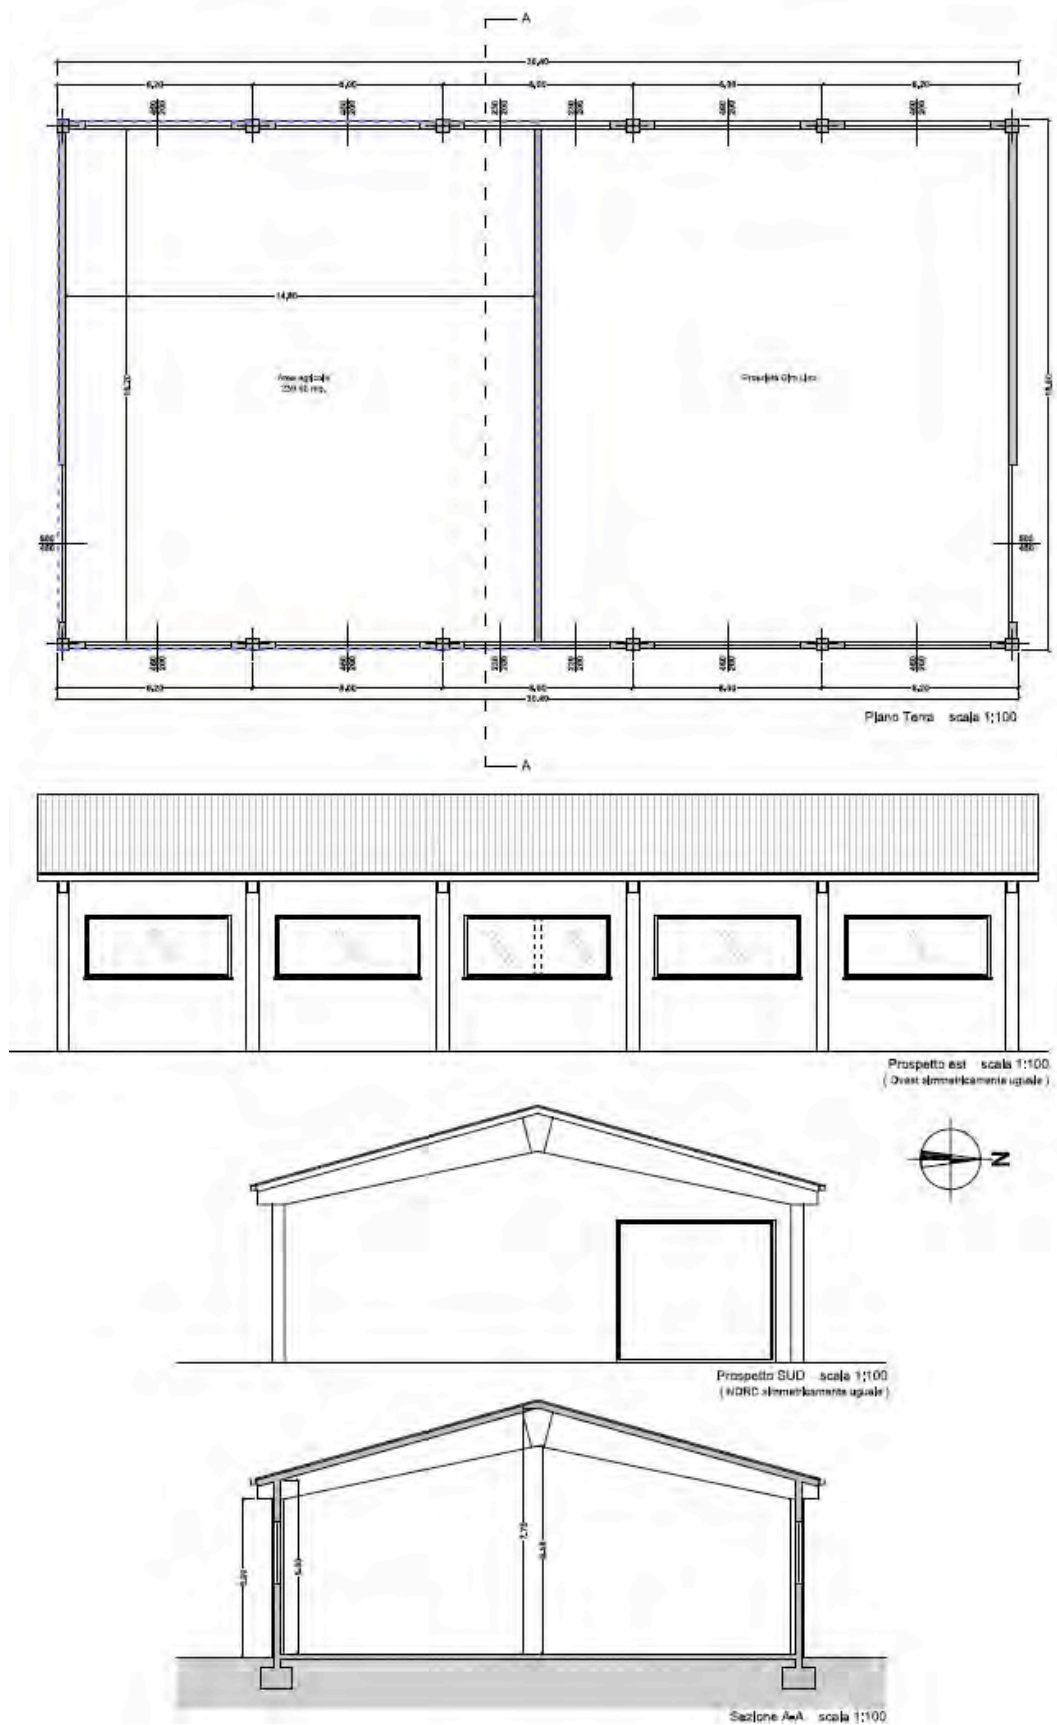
Stato di fatto: planimetria prospetti e sezione - estratto della Tav. 3 di progetto
